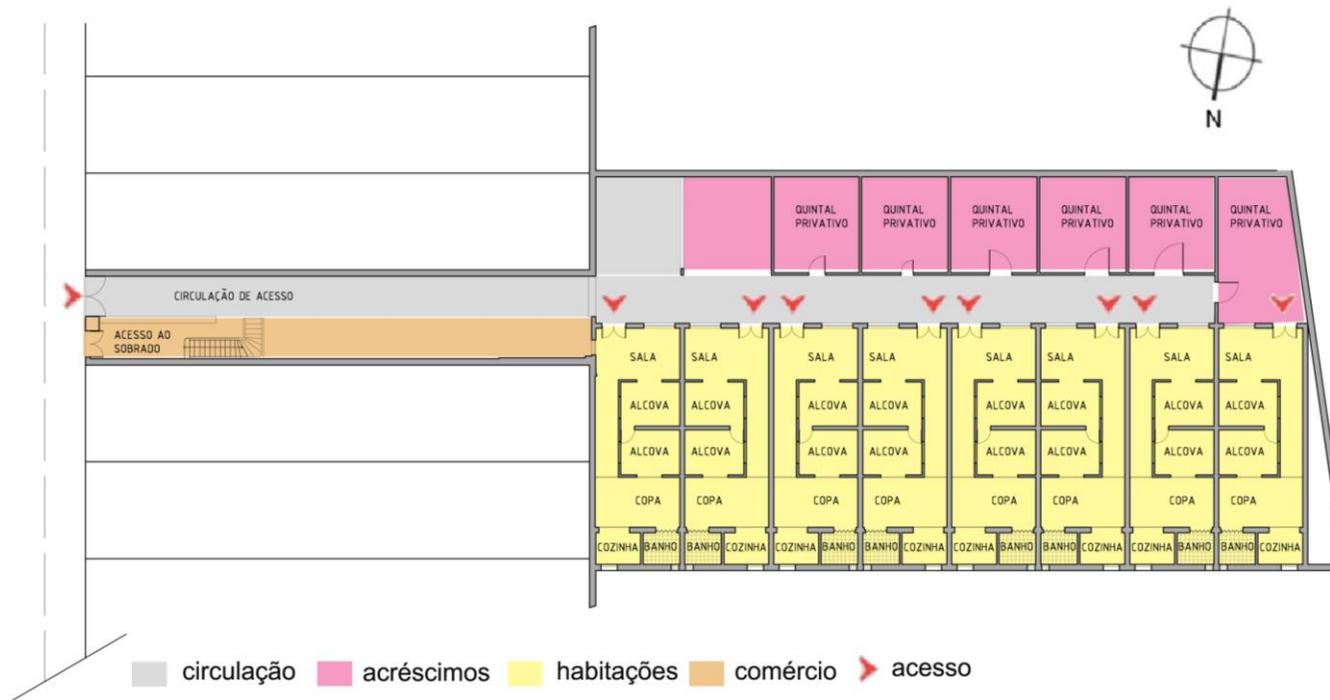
Planta de levantamento do pavimento térreo Setorizado. Fonte: LabHab. Atualizada pela autora Data: 01/2013.
